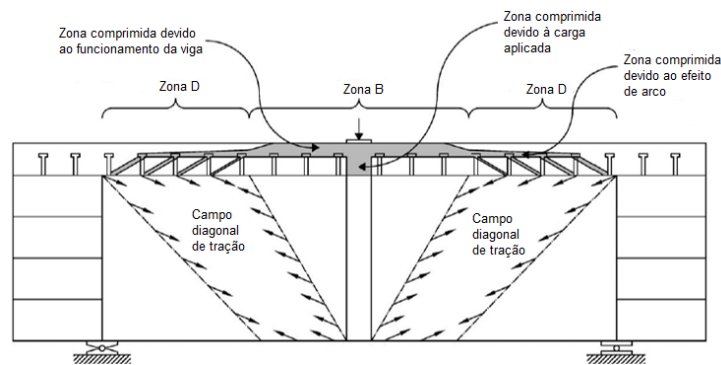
Zonas B e D no plano longitudinal e zonas em compressão da laje de betão. Adaptado de [23]
